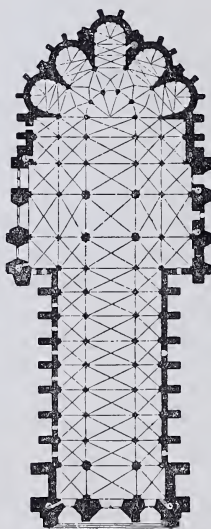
Grundriss der Kathedrale zu Reims.
